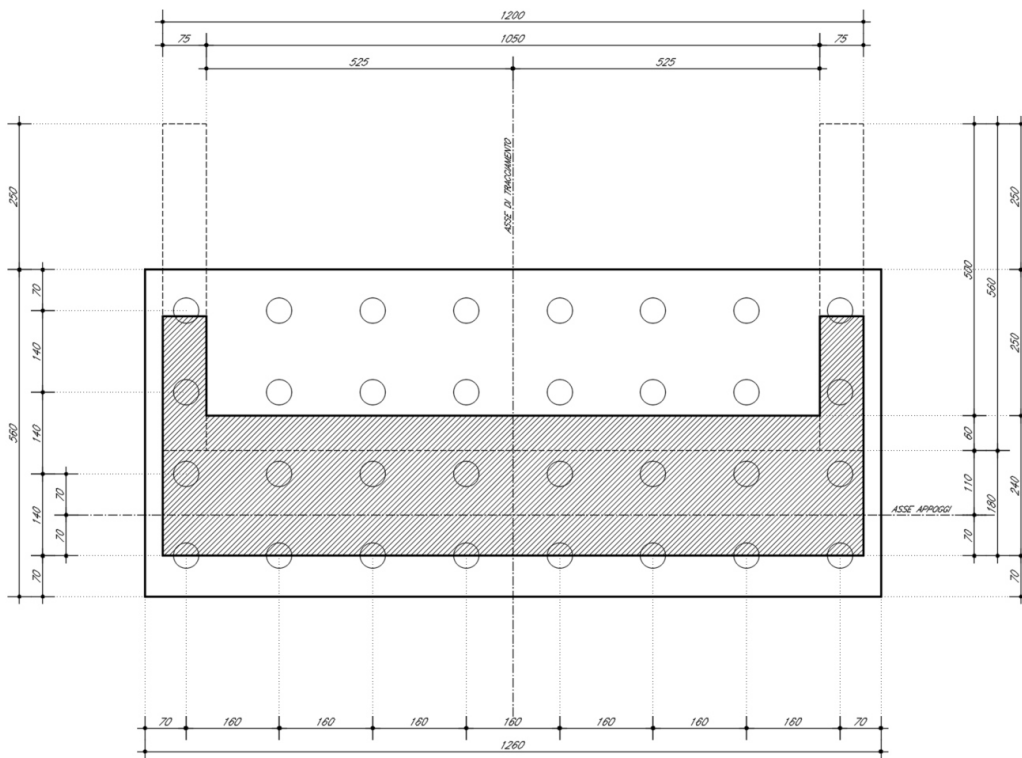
Pianta fondazione e spiccato elevazione spalla A
